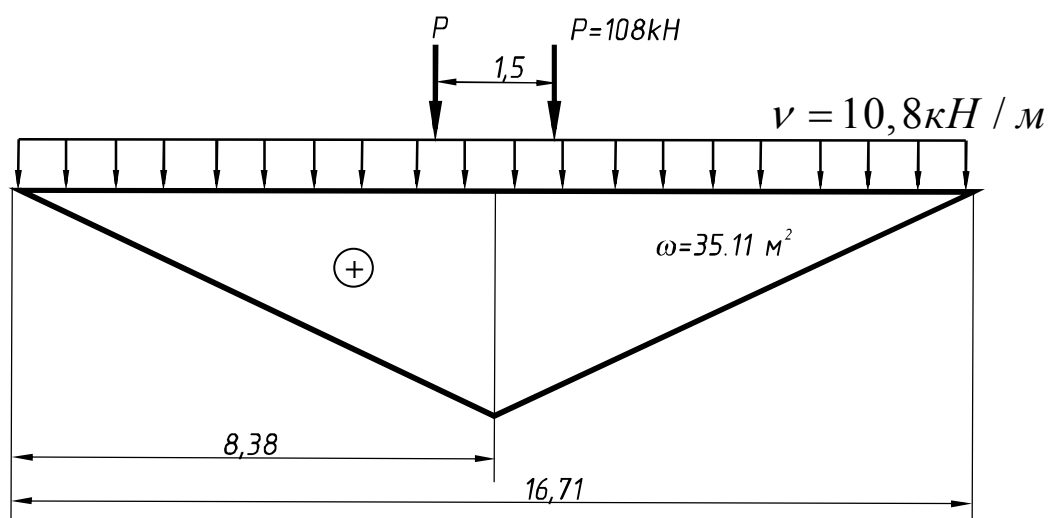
Схема к определению грузоподъемности моста при нагрузке А-11
